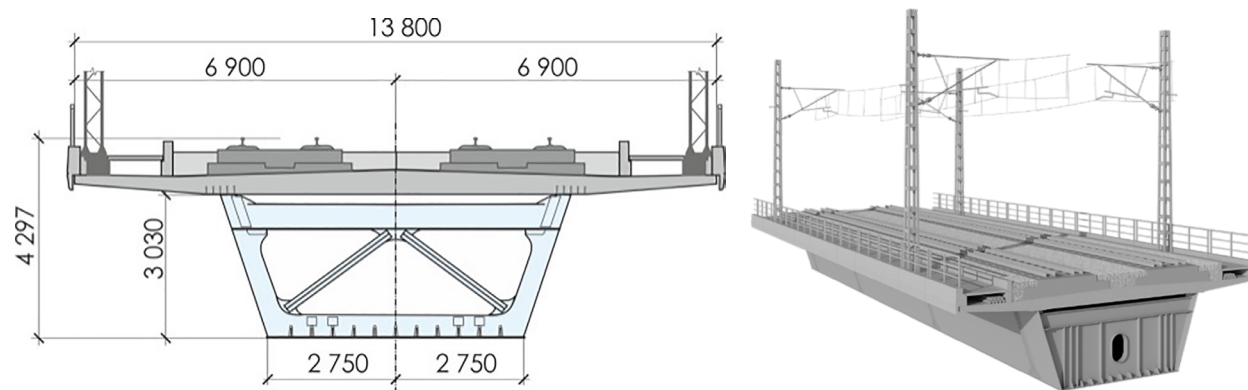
Поперечное сечение сталежелезобетонного пролетного строения полной длиной 34,2 м (расчетный пролет 32,1 м)
